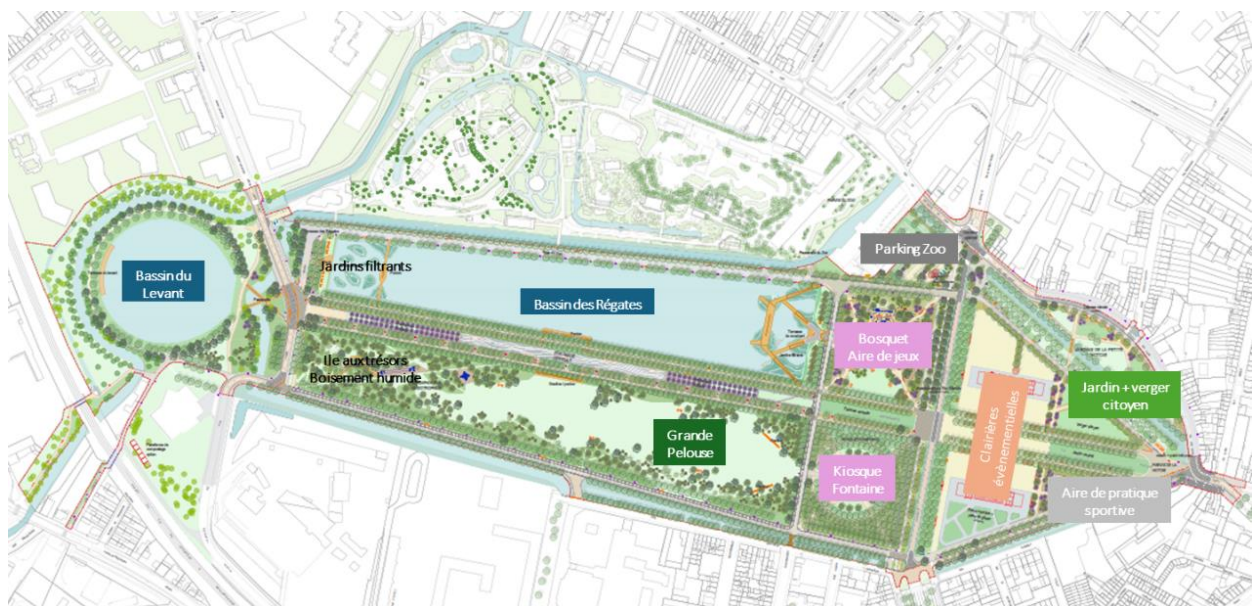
Plan Masse du projet d'aménagement du parc de la Hotoie (AVP - BASE, mars 2024)
